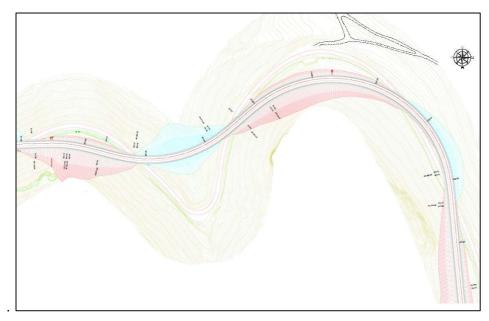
Trazado en planta de un tramo de la Alternativa 2
